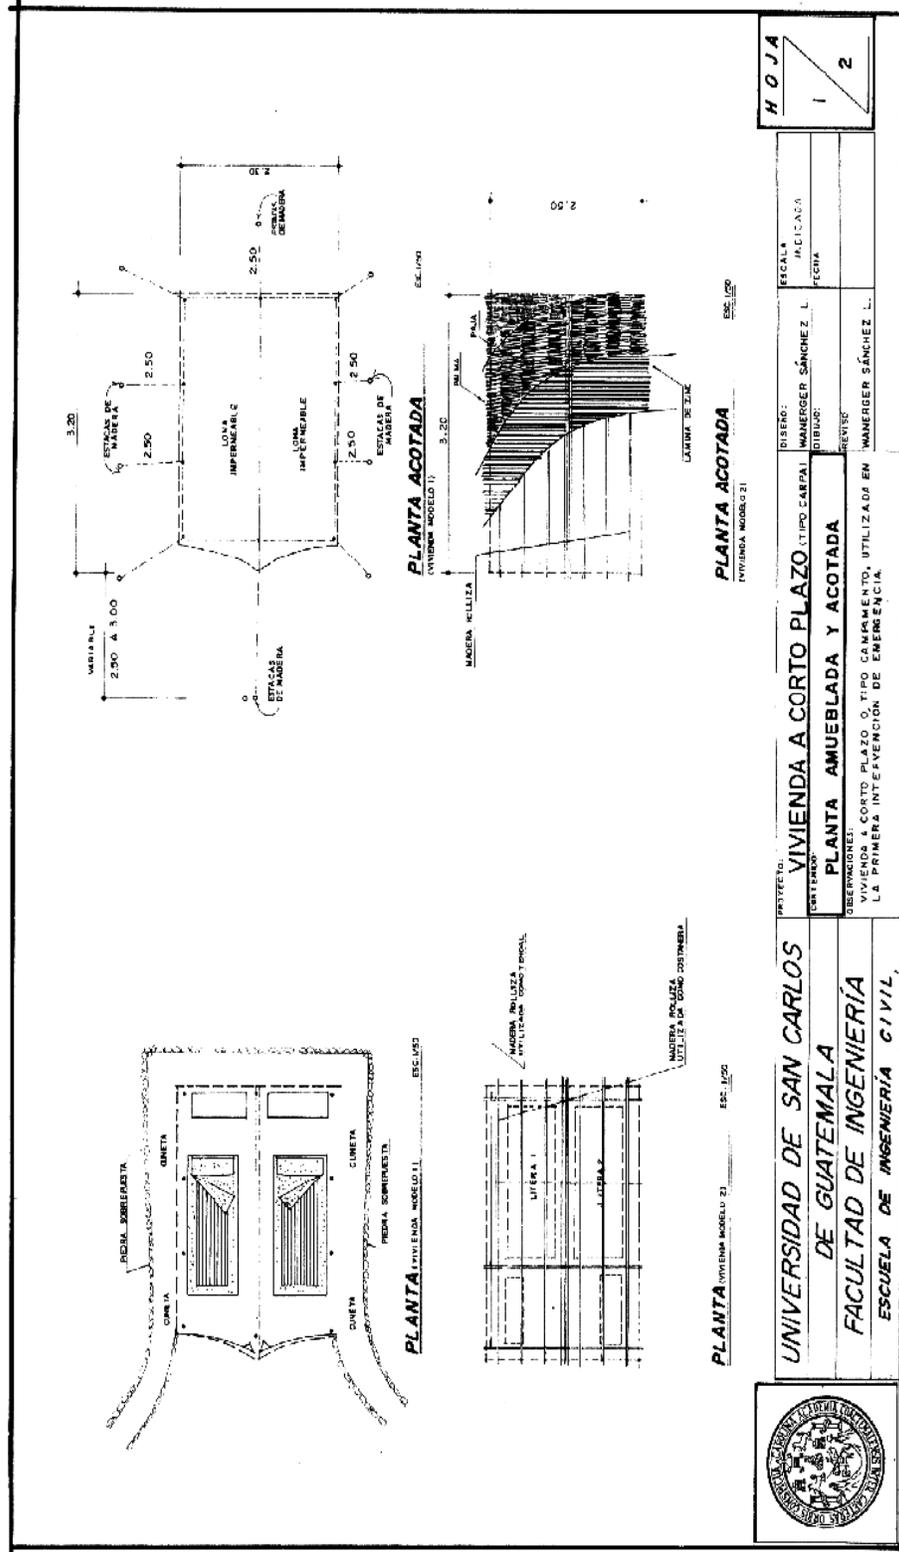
Vivienda a corto plazo (tipo campamento), planta de instalación de dos modelos de vivienda y materiales utilizados.
